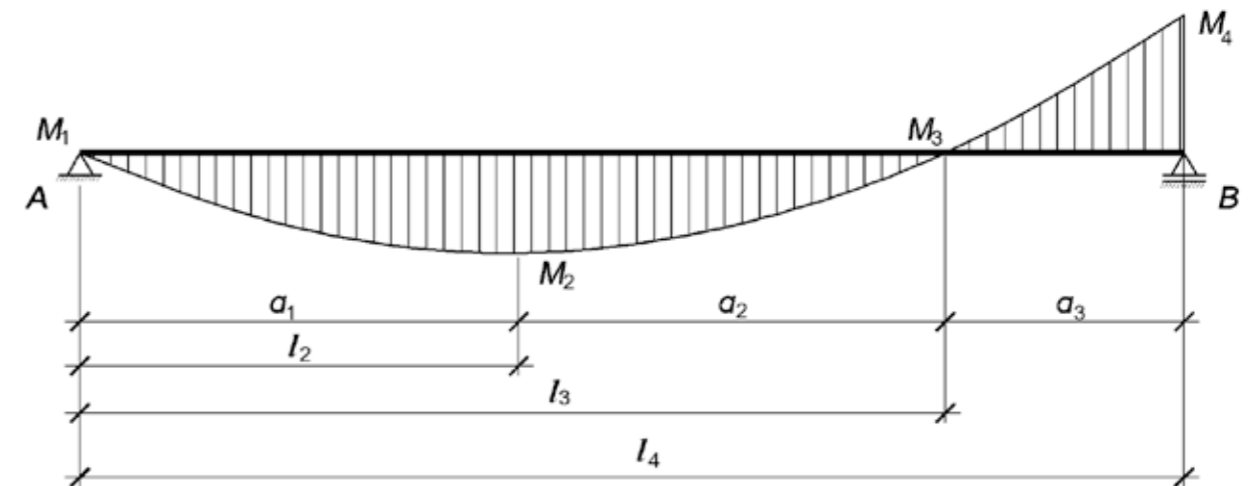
Схема расположений расчетных сечений при расчете на сдвигающее усилие на эпюре моментов
